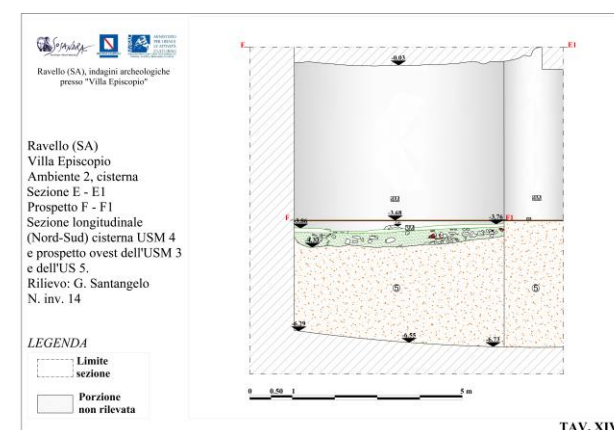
Ravello (SA) Villa Episcopo Ambiente 2, cisterna Sezione E - E1 Prospetto F - F1 Sezione longitudinale (Nord-Sud) cisterna USM 4 e prospetto ovest dell'USM 3 e dell'US 5. Rilievo: G. Santangelo N. inv. 14
